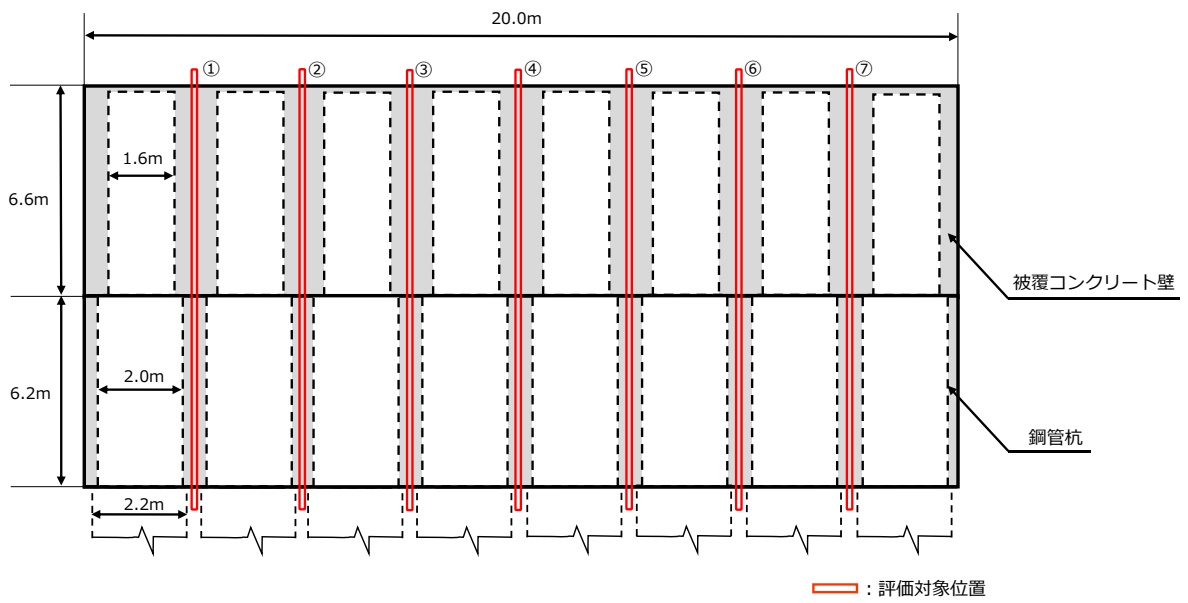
(4) 評価対象位置図 (③-③断面 正面図)
